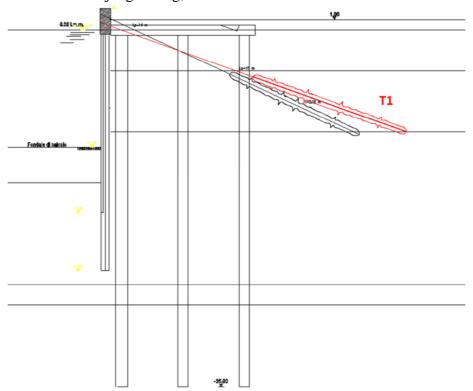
Sezione tipo intervento di adeguamento con indicazione dei tiranti di ancoraggio
